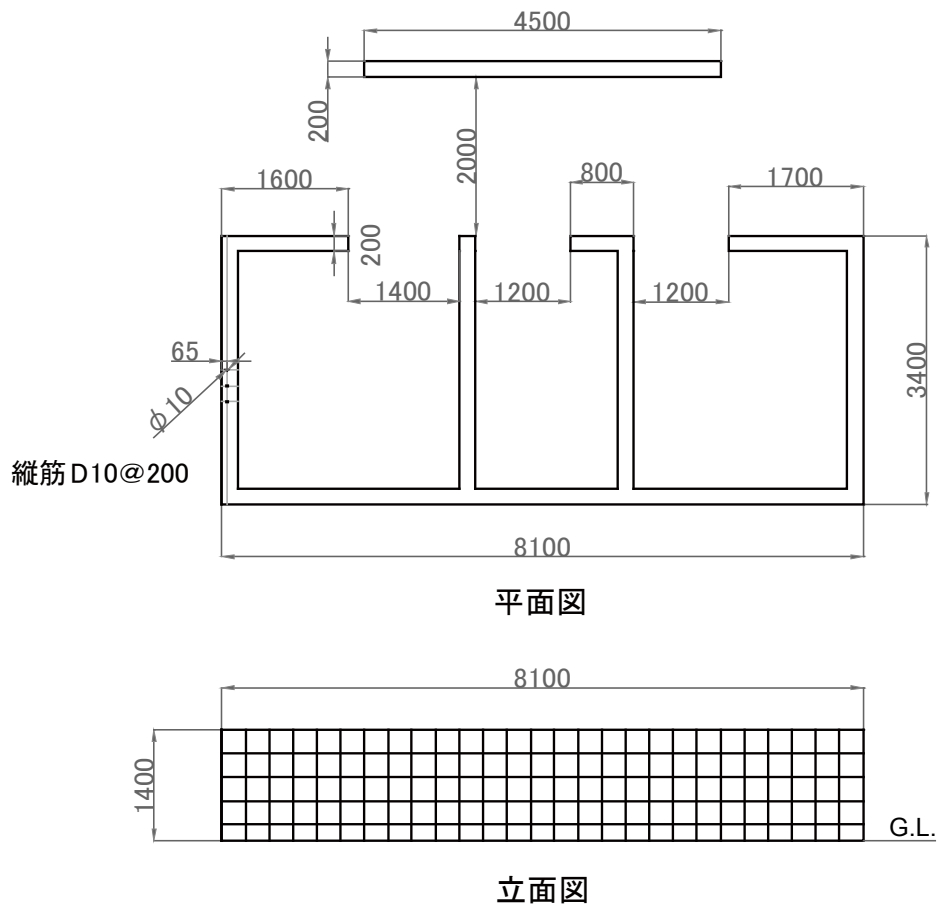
調査対象構造物 立面図・平面図 (単位: mm)
